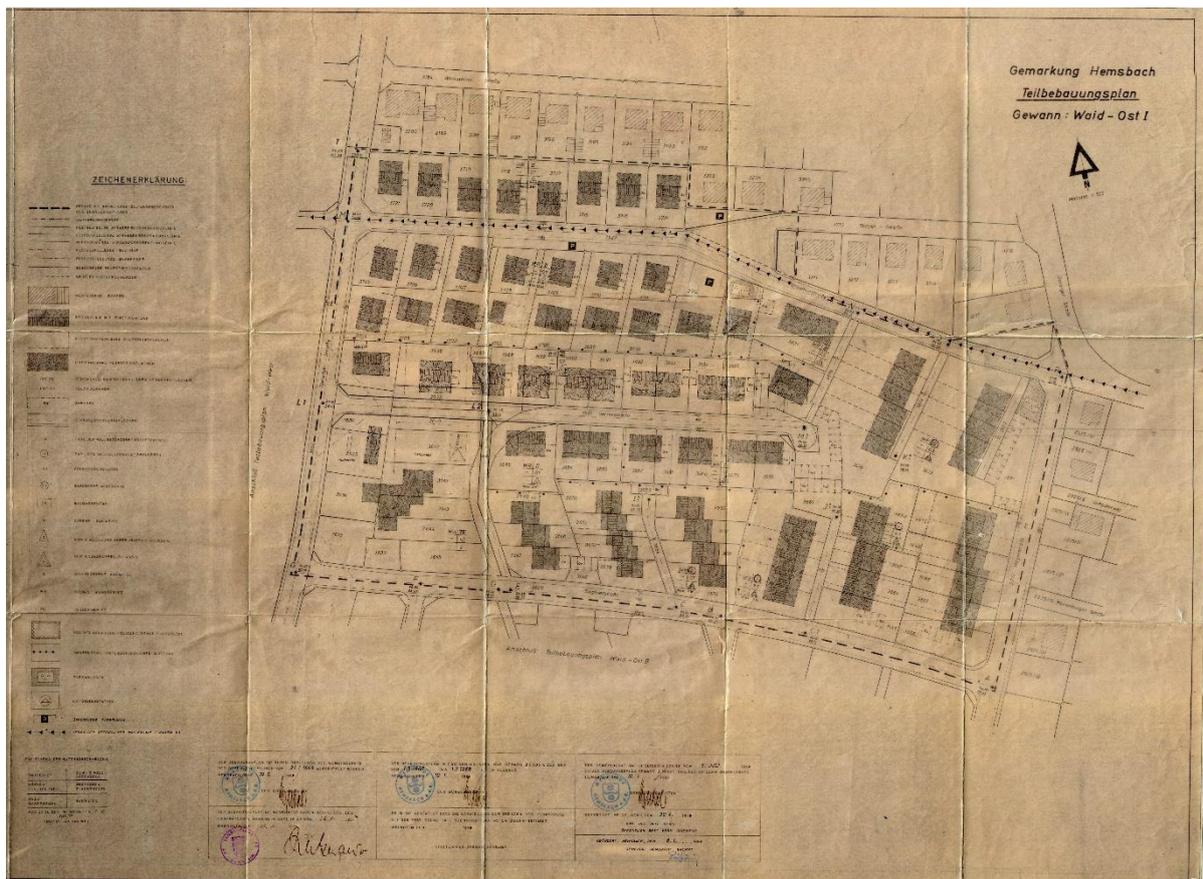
Bebauungsplan „Waid-Ost I“, 1969.
